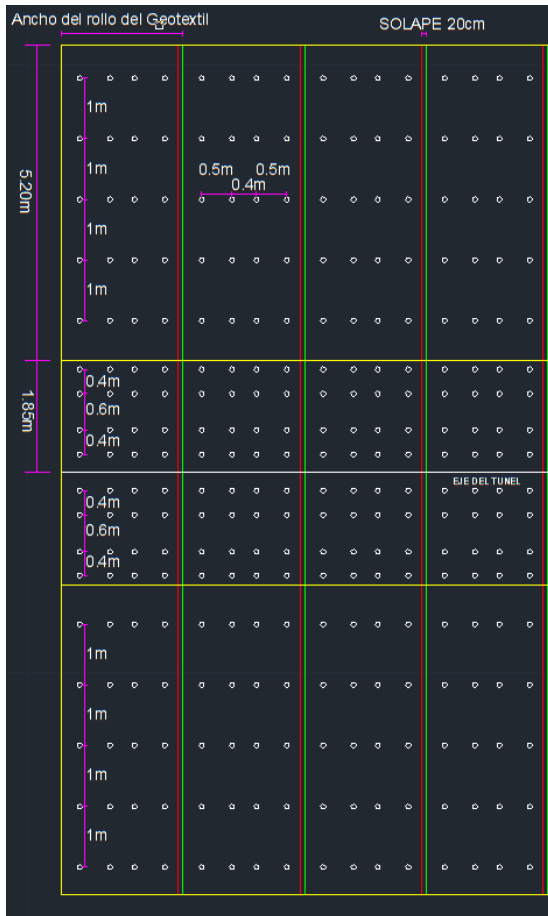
Sistema de fijación del Geotextil, vista en planta
